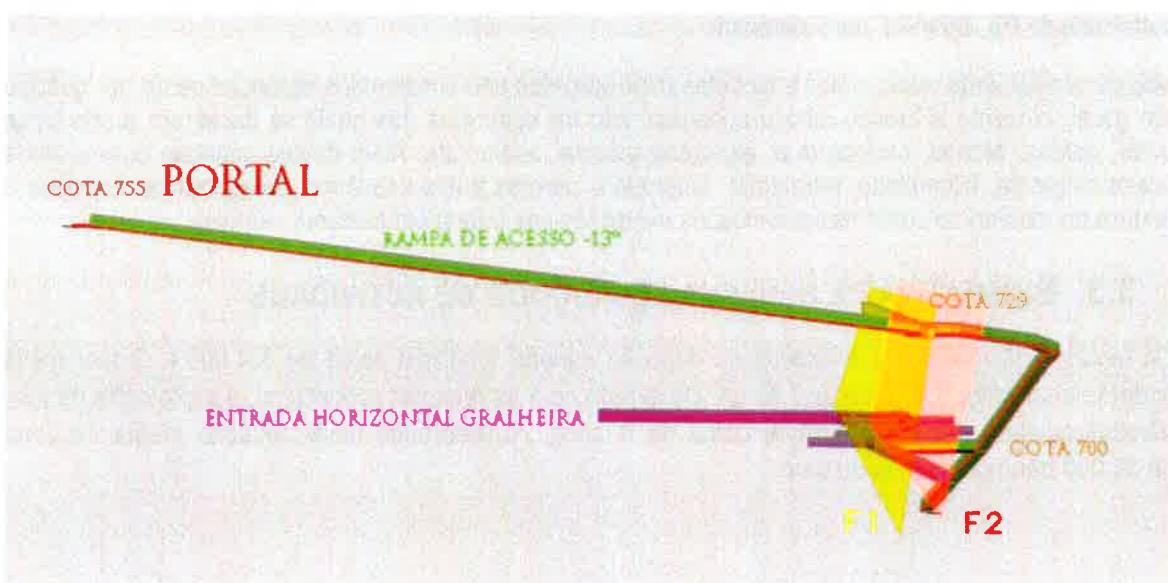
Corte em 3D da vista Oeste da Rampa de Acessos Norte
